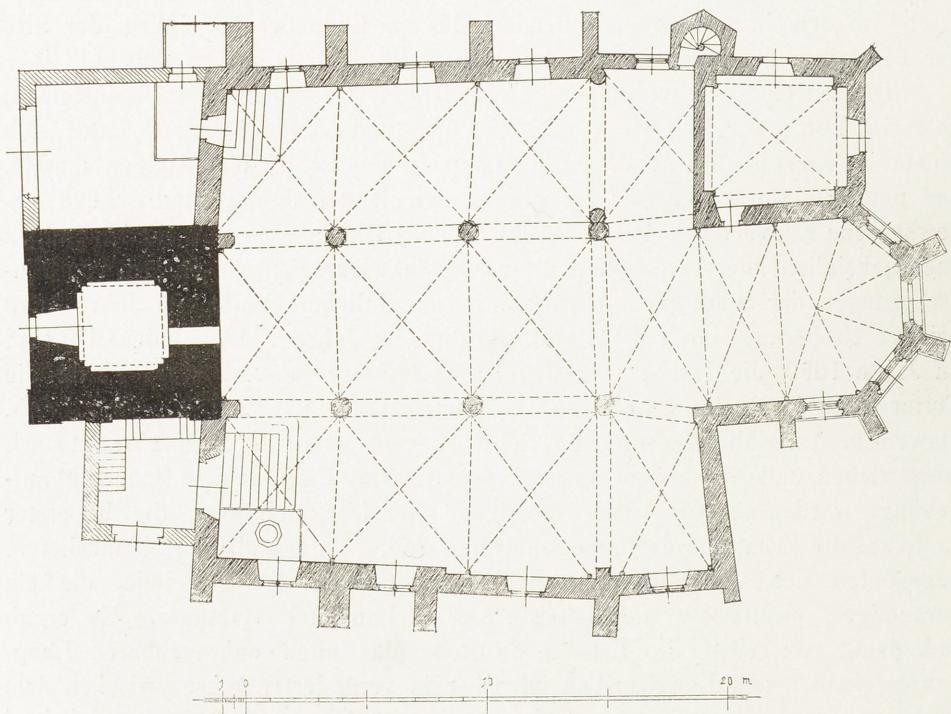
St. Vith. Grundriss der kathol. Pfarrkirche vor der Erweiterung.
